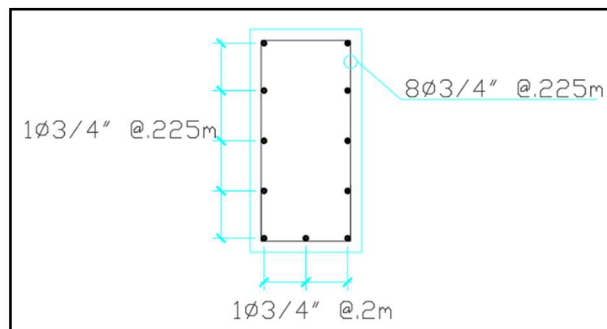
Distribución acero refuerzo viga 1.00 m x 0.50 m.
